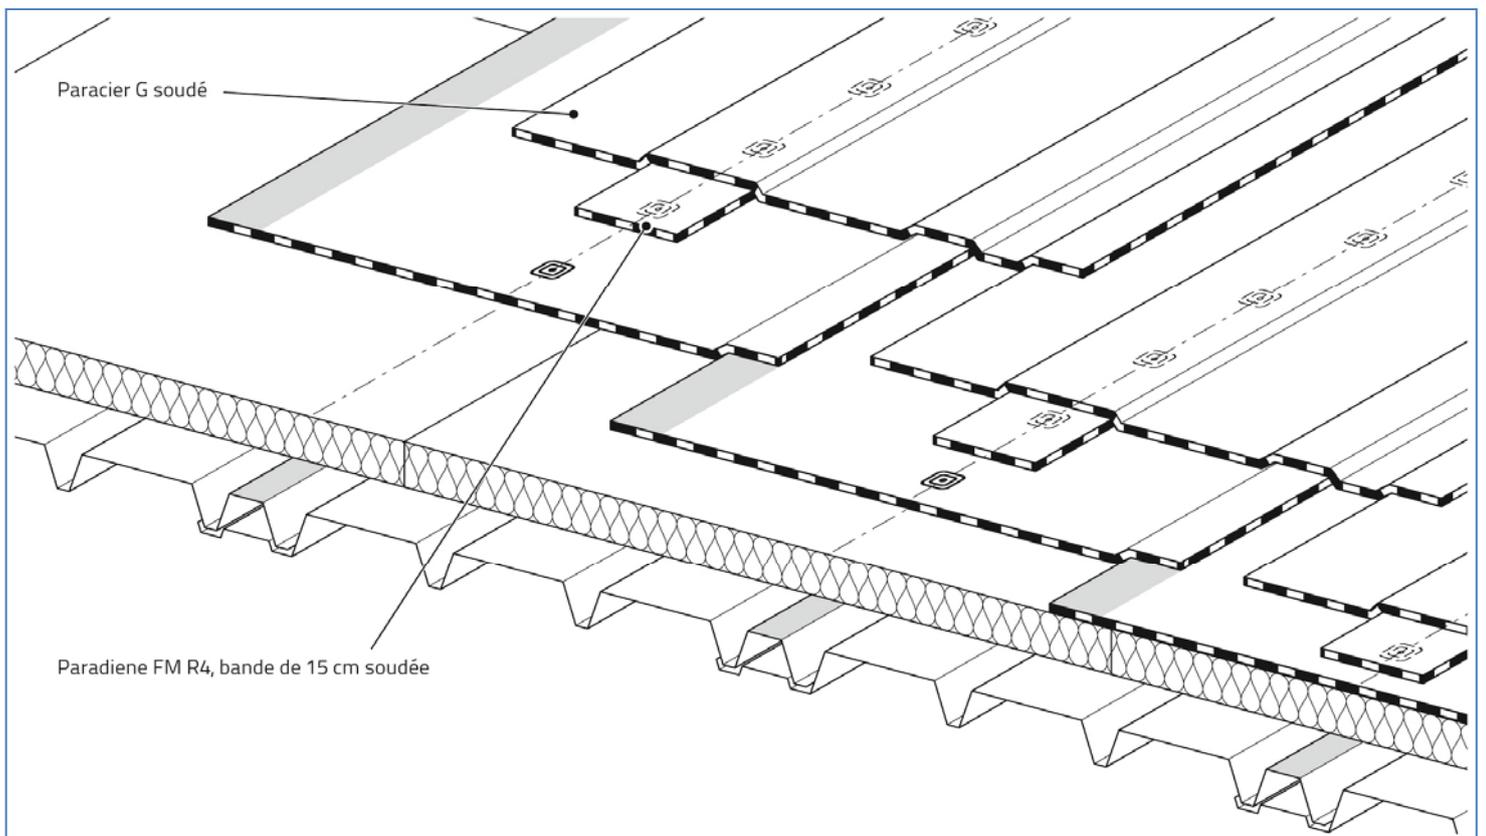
Revêtement d'étanchéité bicouche soudé et fixé mécaniquement (avec bandes de pontage)
